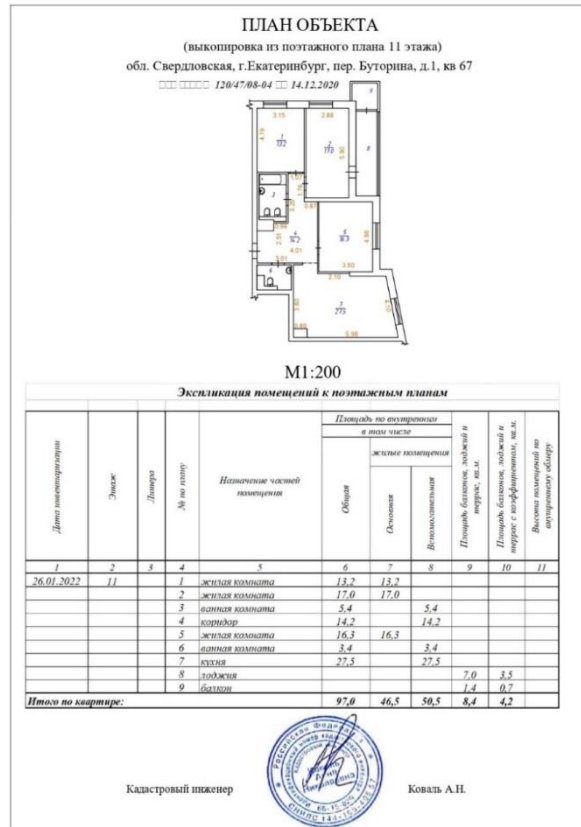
План объекта (выкопировка из поэтажного плана 11 этажа)
